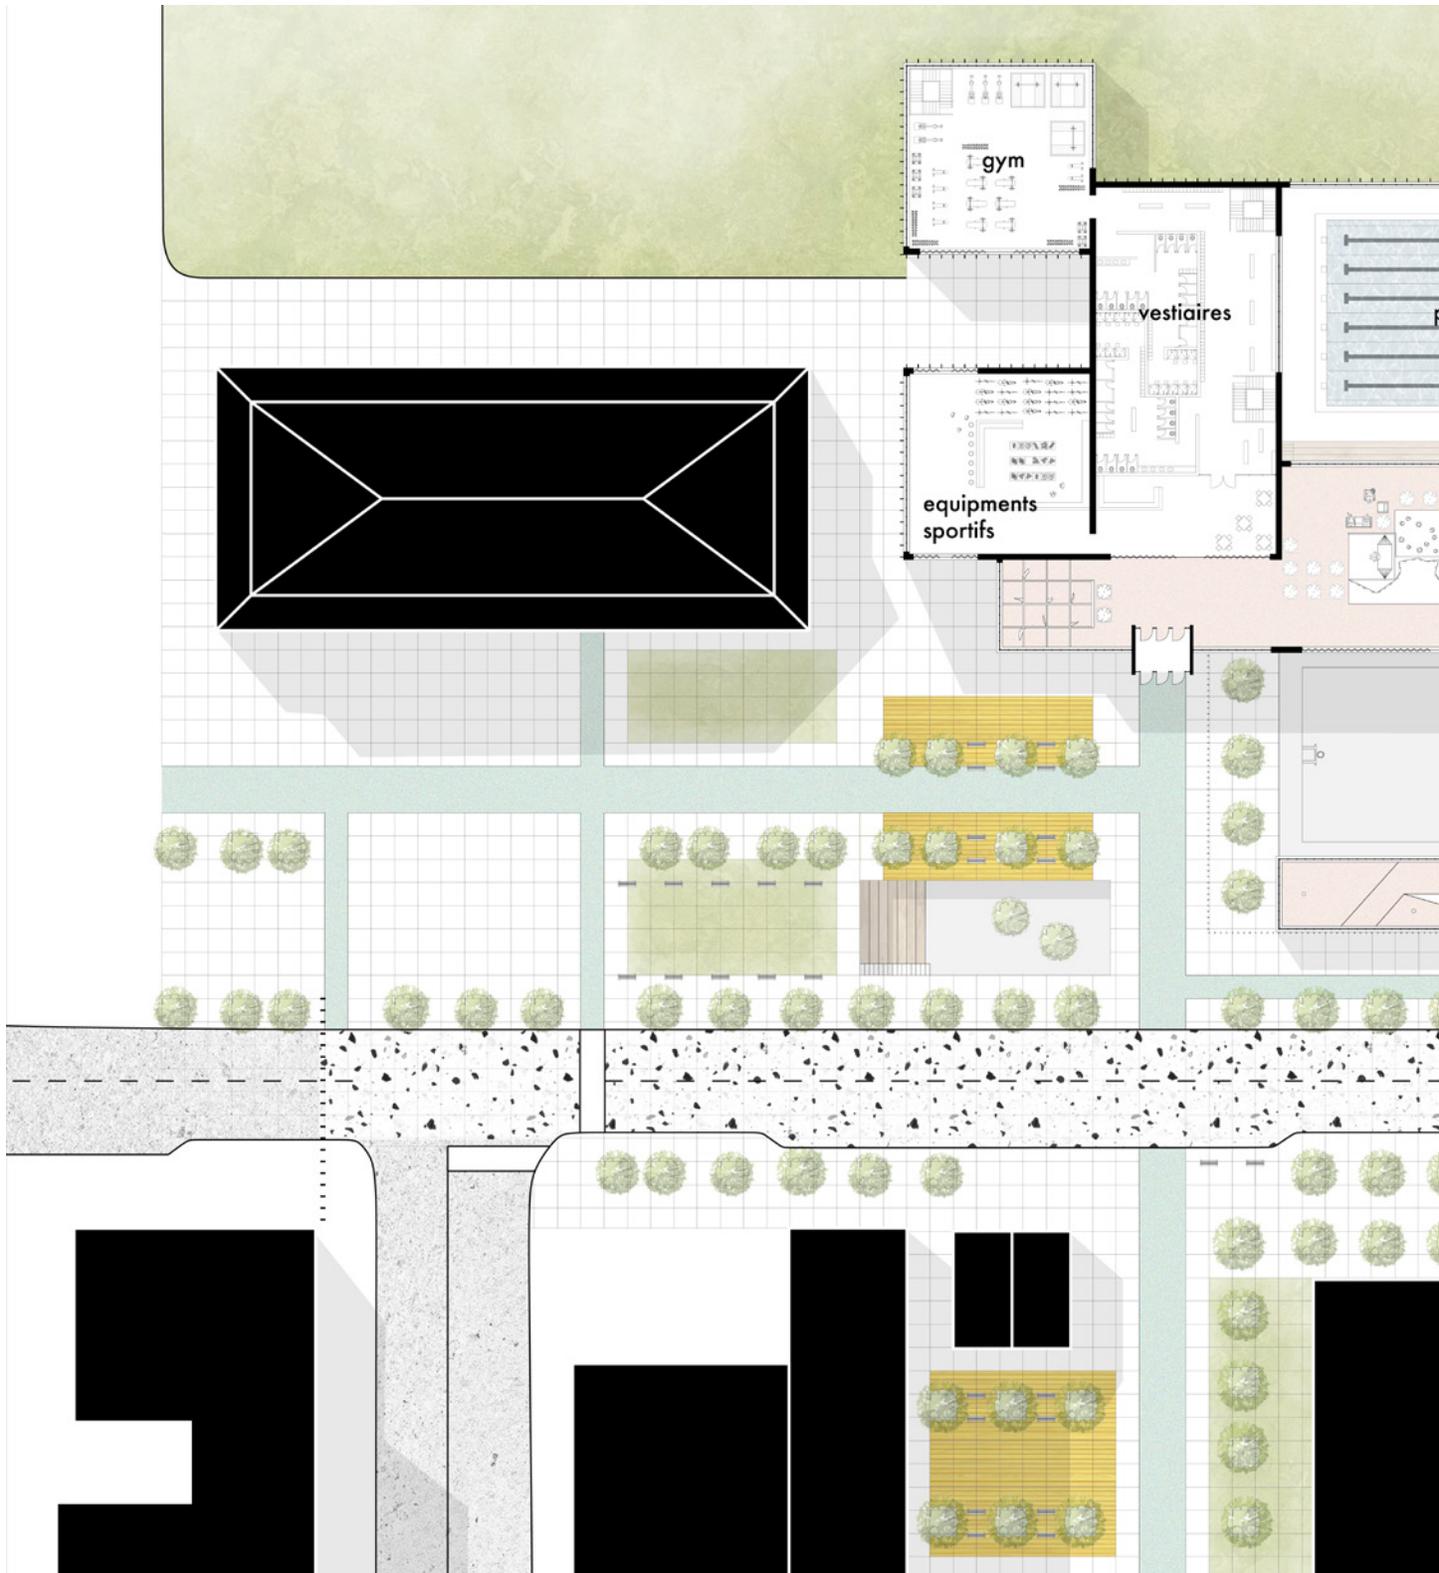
Plan du rez-de-chaussée (par l'auteur)
